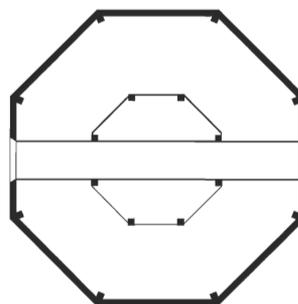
Fig. IV - VUE EN PLAN, À LA HAUTEUR DES COMBLES
